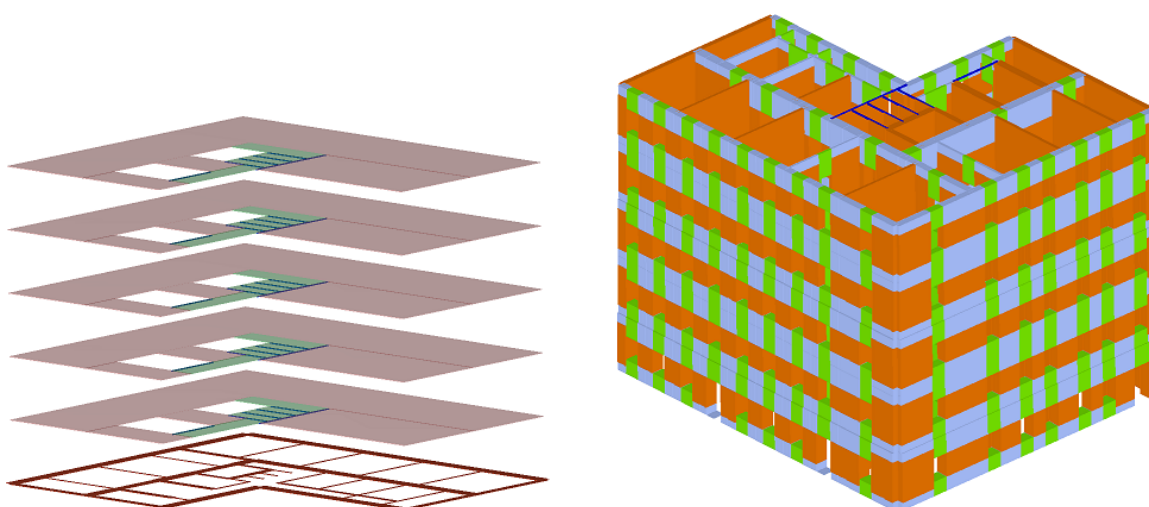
unsymmetrischer Grundriss, Links: Mauern im Erdgeschoss inklusive der darauf folgenden Deckenebenen; Rechts: Einteilung der Makro-Elemente
